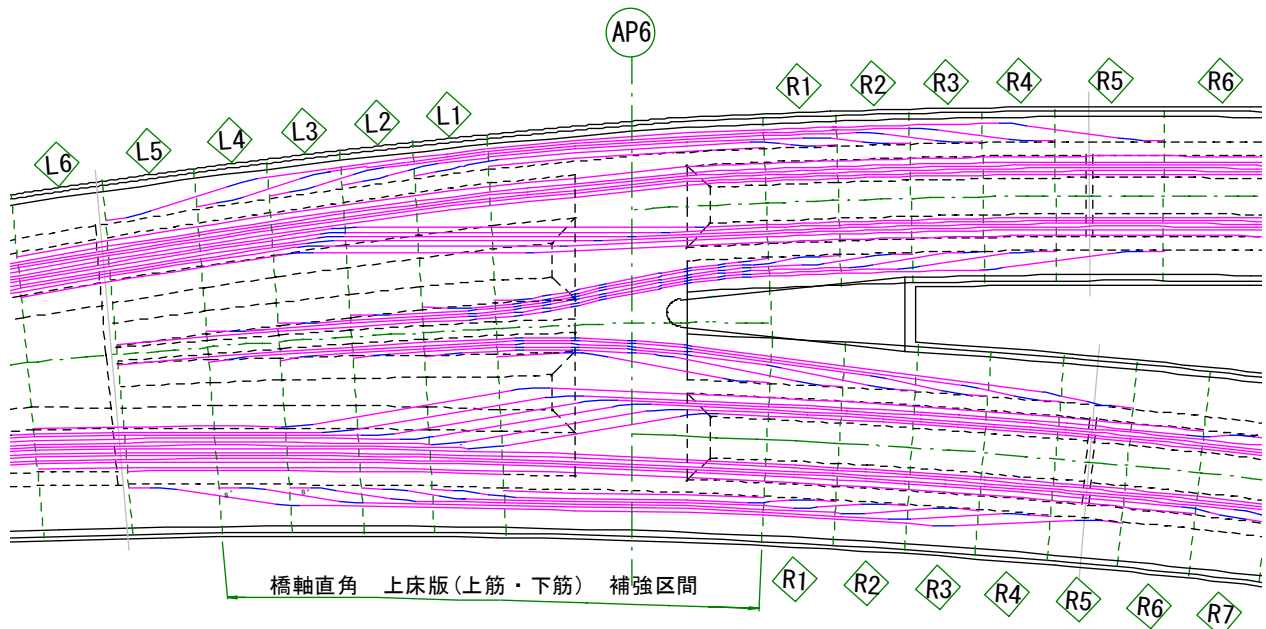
AI ランプ高架橋分岐の内ケーブル配置(平面図)
